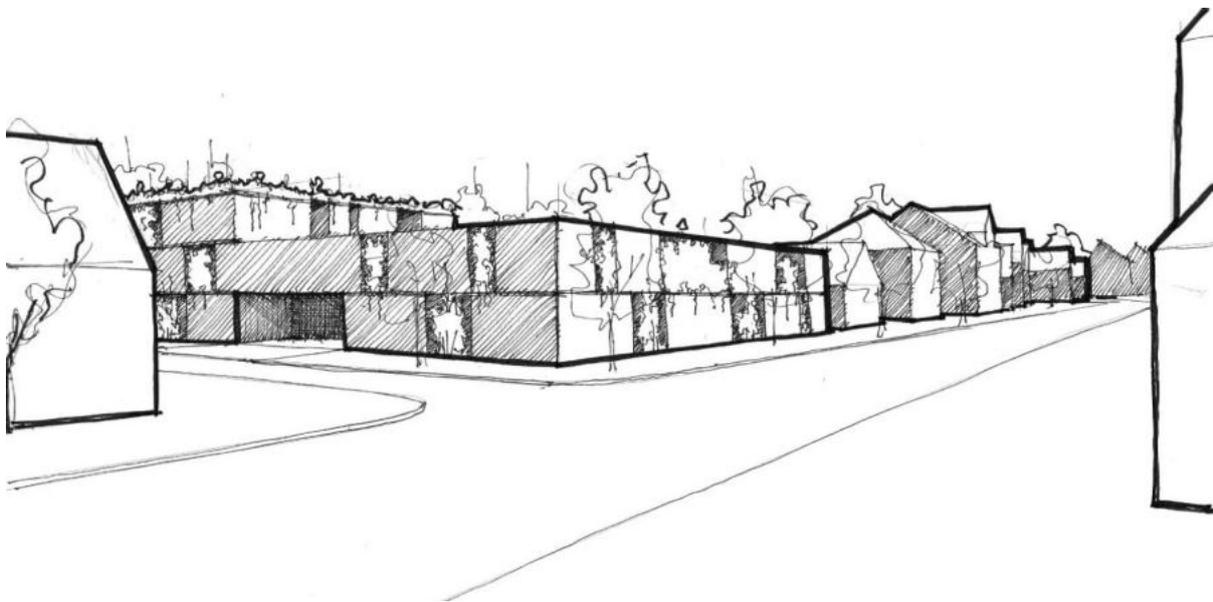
Skizze Parkhaus Ecke Breite Straße
